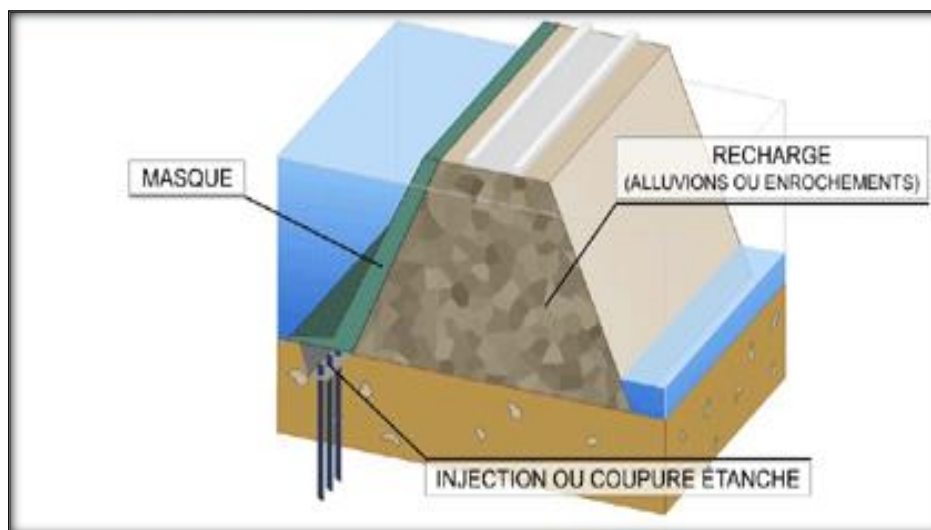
Barrage à masque (Procèdes généraux de construction des barrages)
